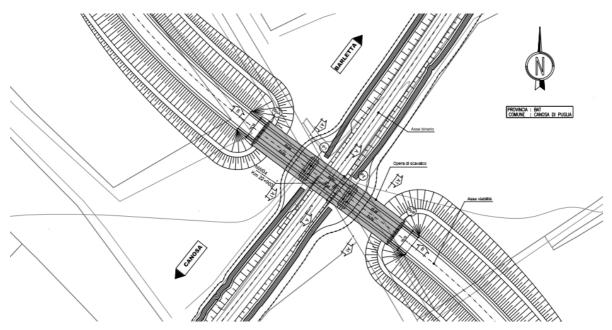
Cavalcaferrovia NW04 – Planimetria
